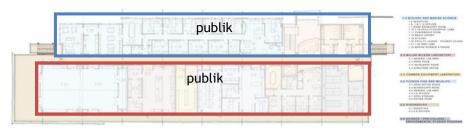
28 Site plan studi zoning tapak (Sumber: Hota Design Studio, 2011)
